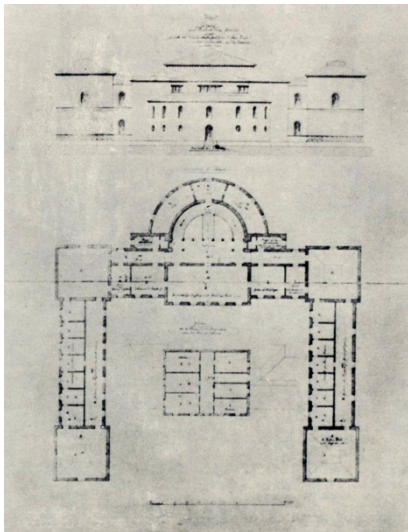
Entwurf für das *Stuttgarter Kunstgebäude* von *Nicolaus Friedrich von Thouret* 1837-38; Fassadenaufriss und Grundriss Obergeschoss;
